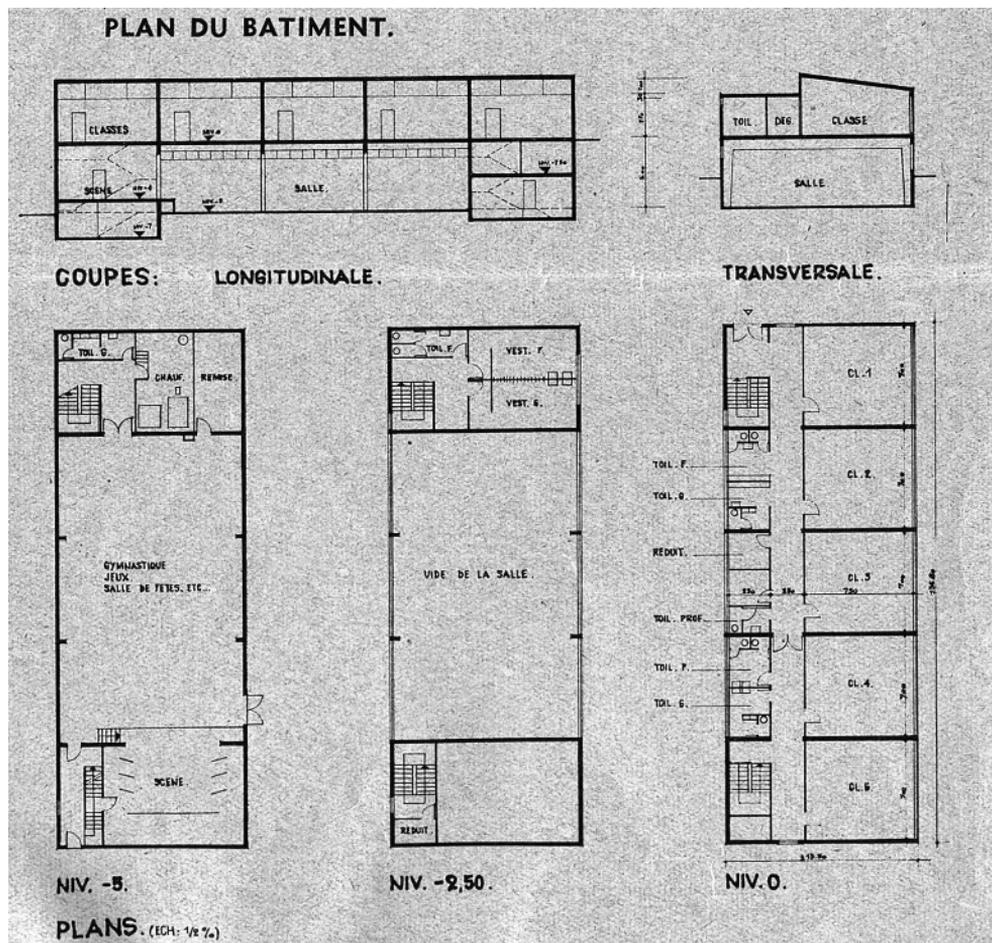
Grundriss des Neubauprojekts (1961) (CED, Brochures, Nous Bâtissons, 1960)
